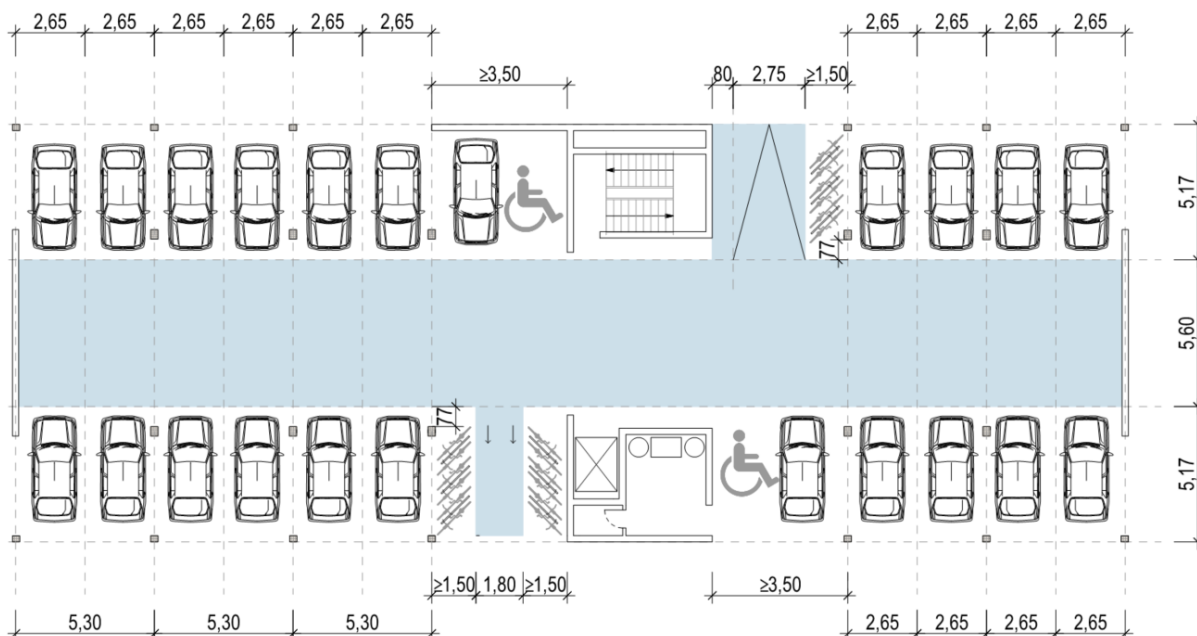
Grundrissvariante Garagenfläche für Konzept 2
